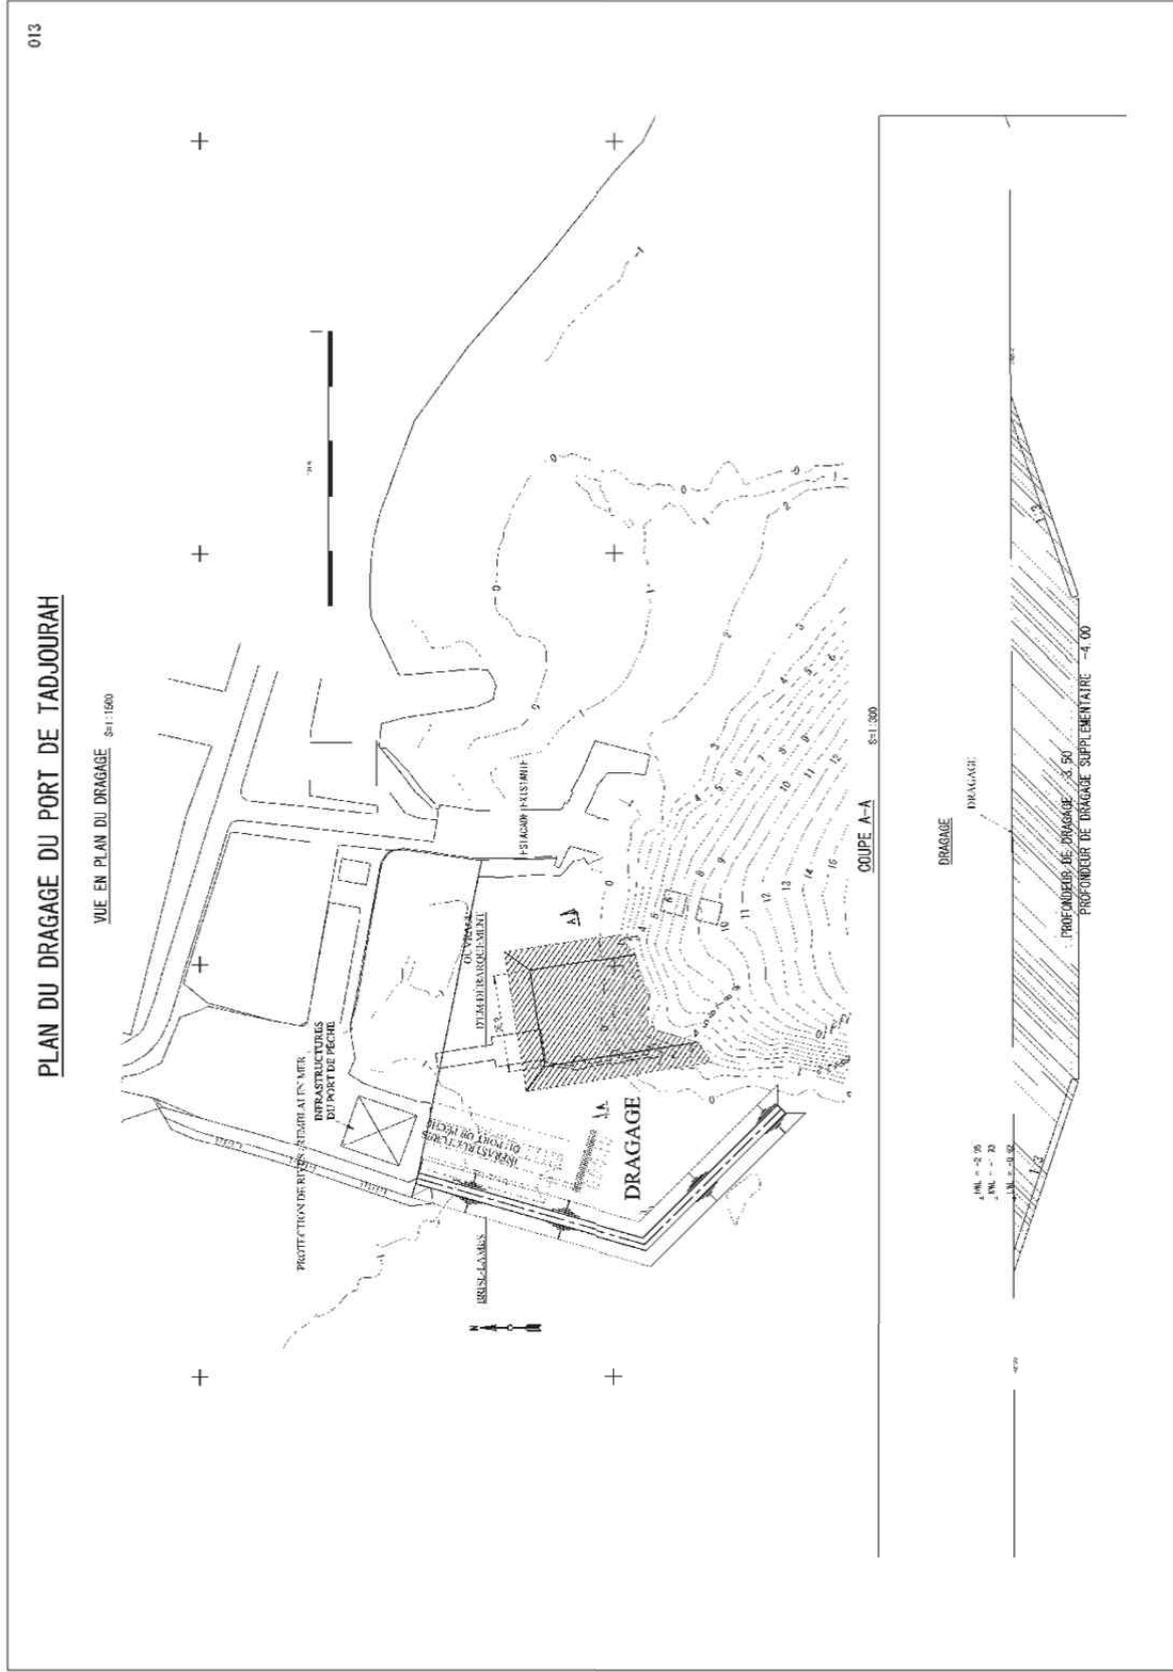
Plan du dragage du Port de Tadjourah
